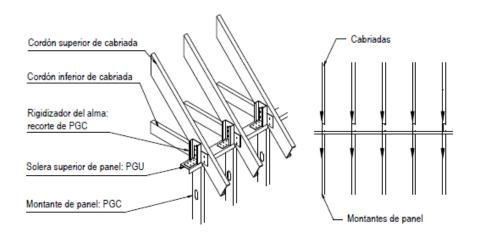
Estructura de cubierta modulada. Fuente: (ConsulSteel, 2014).
